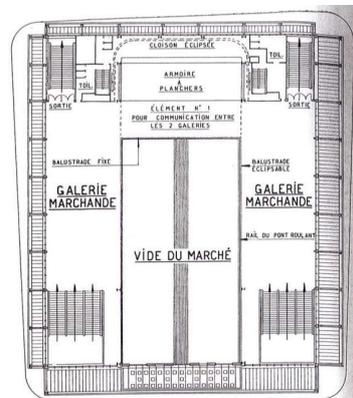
Plan des galeries du marché. Elles sont reliées par une passerelle constituée par l'élément n° 1 du plancher mobile.
